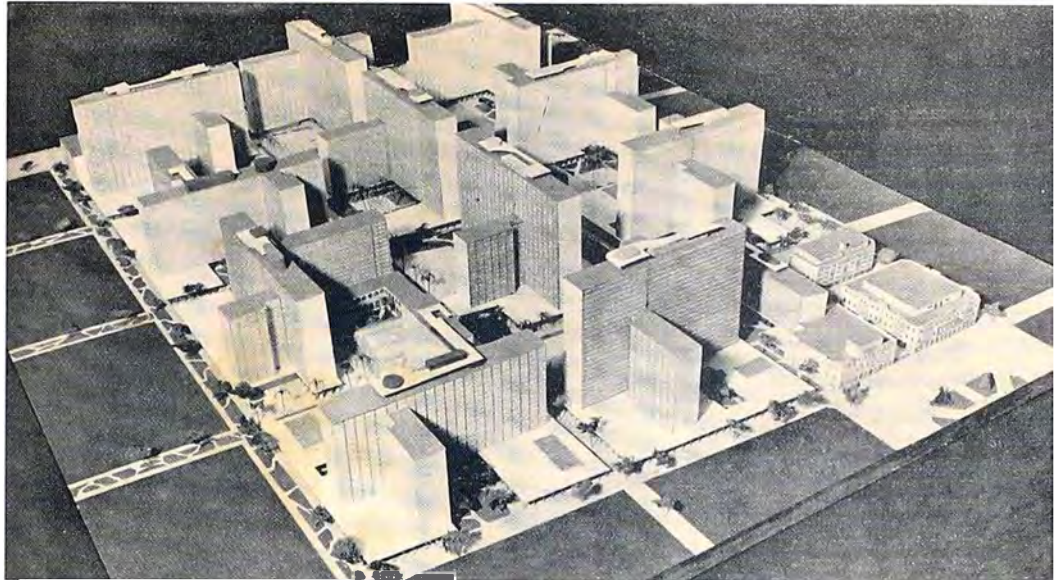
Maqueta del Sector Central del Plan Piloto, 1949. área comprendida entre la Plaza de Armas, Jr. Conde de Superunda, Av. Tacna, y Jr. Huancavelica. PPL.
